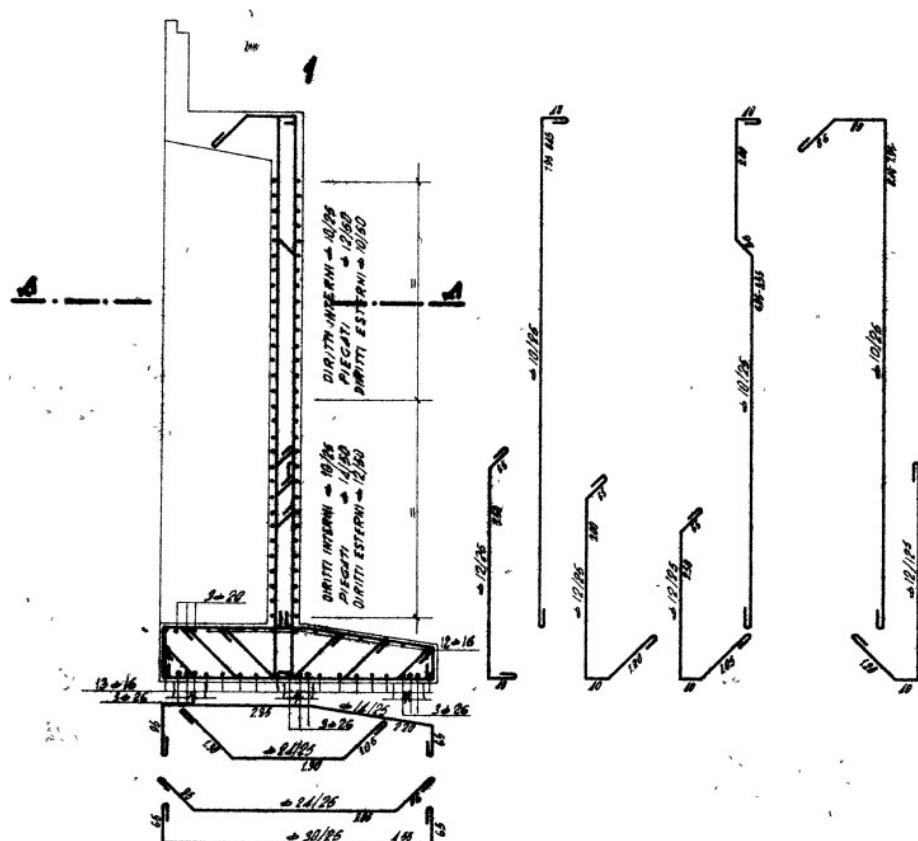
Documento as-built “Sottovia Interconnessione 1 dell’autostrada A14 al km 14+232” – Sezione trasversale con armature spalla.
